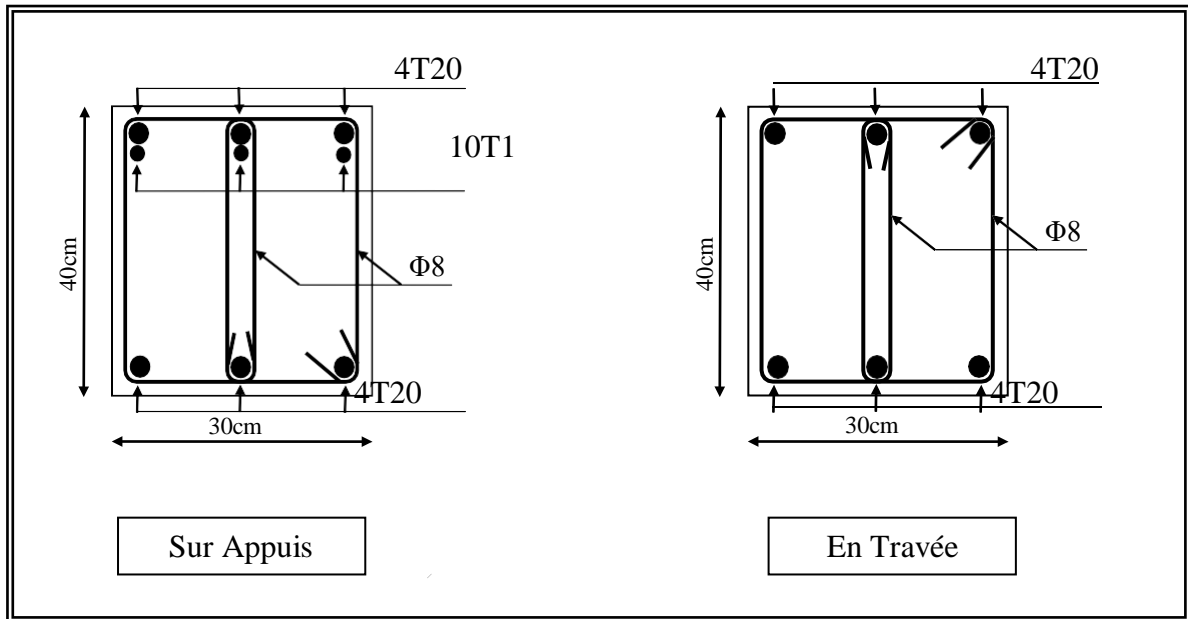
Ferrailage de la Poutre porteuse de 9^{ème} étage
